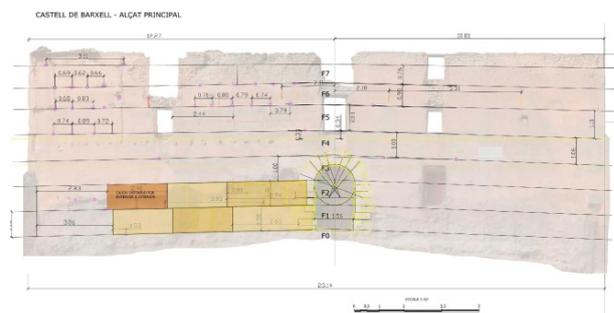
Fachada principal. Estudio de la tapia sobre alzado.
